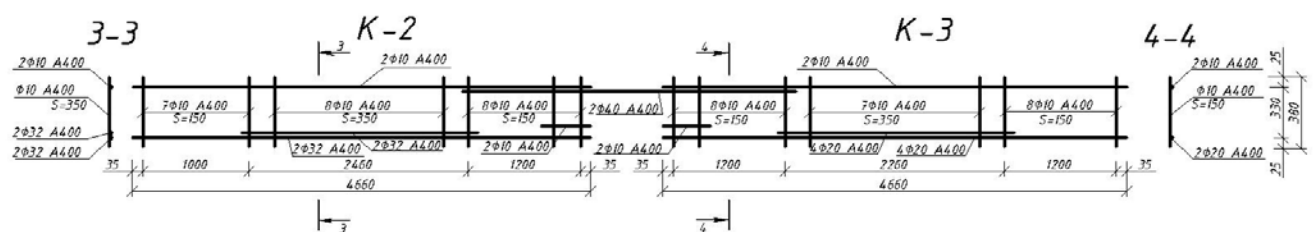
Армирование ригеля поперечным каркасом.
